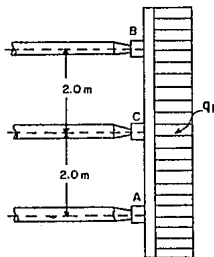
Ademodo de una excavación mediante tablas horizontales
